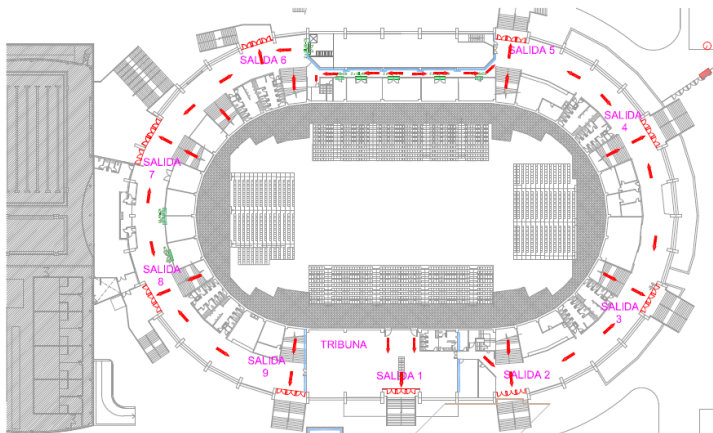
Plano Planta Vías de Evacuación Gradas. Plano Planta 6.
